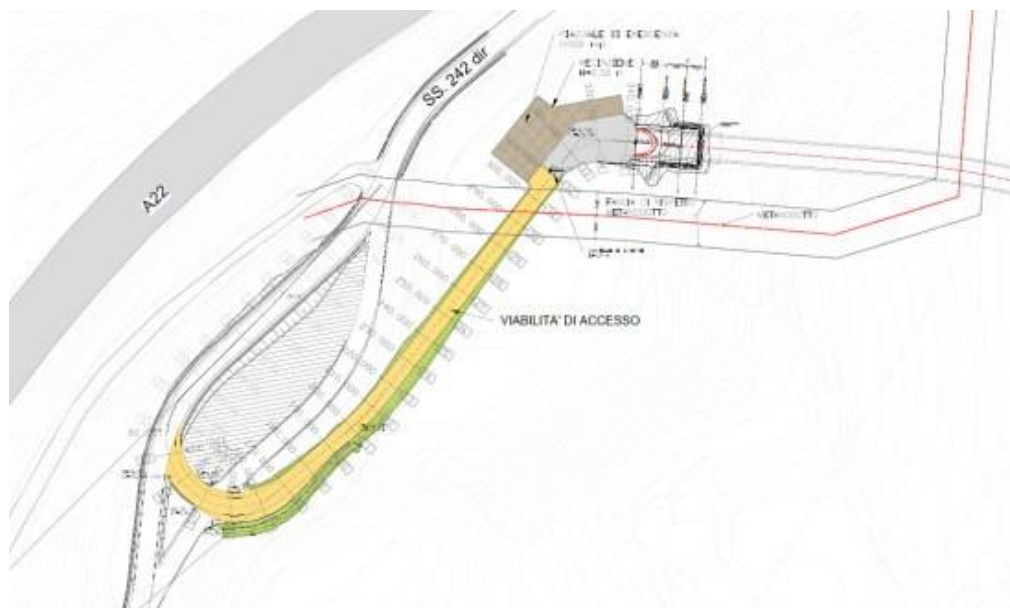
Planimetria viabilità accesso piazzale Chiusa NV072
